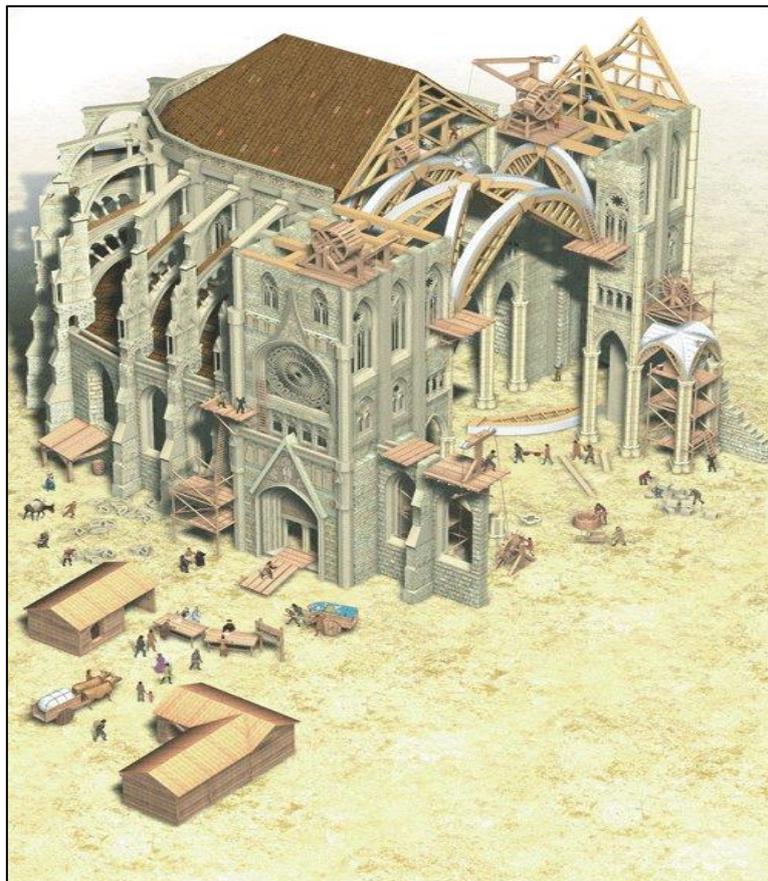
Sección del proceso constructivo de una catedral con grúas de tracción humana en la cubierta.
